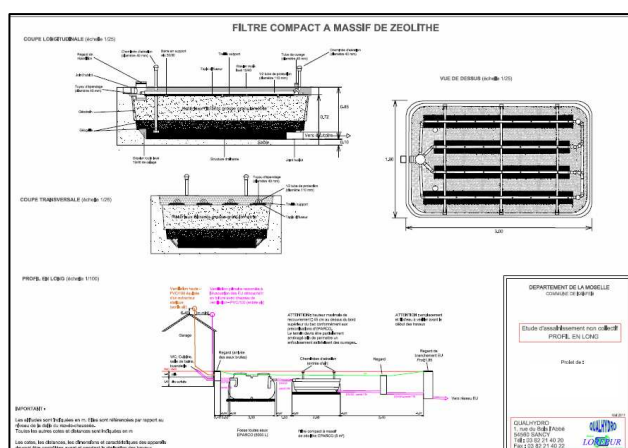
plan en coupe d'un projet d'assainissement non collectif
